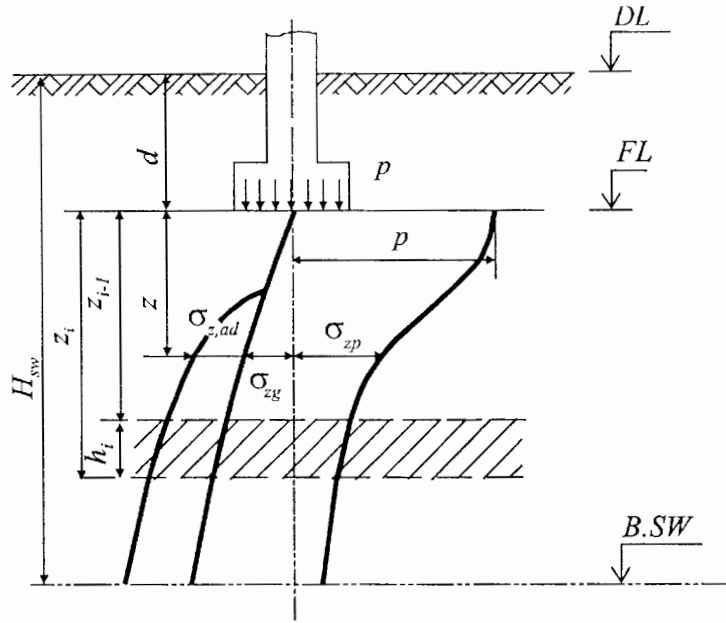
Схема до розрахунку підйому основи при набряканні ґрунту
